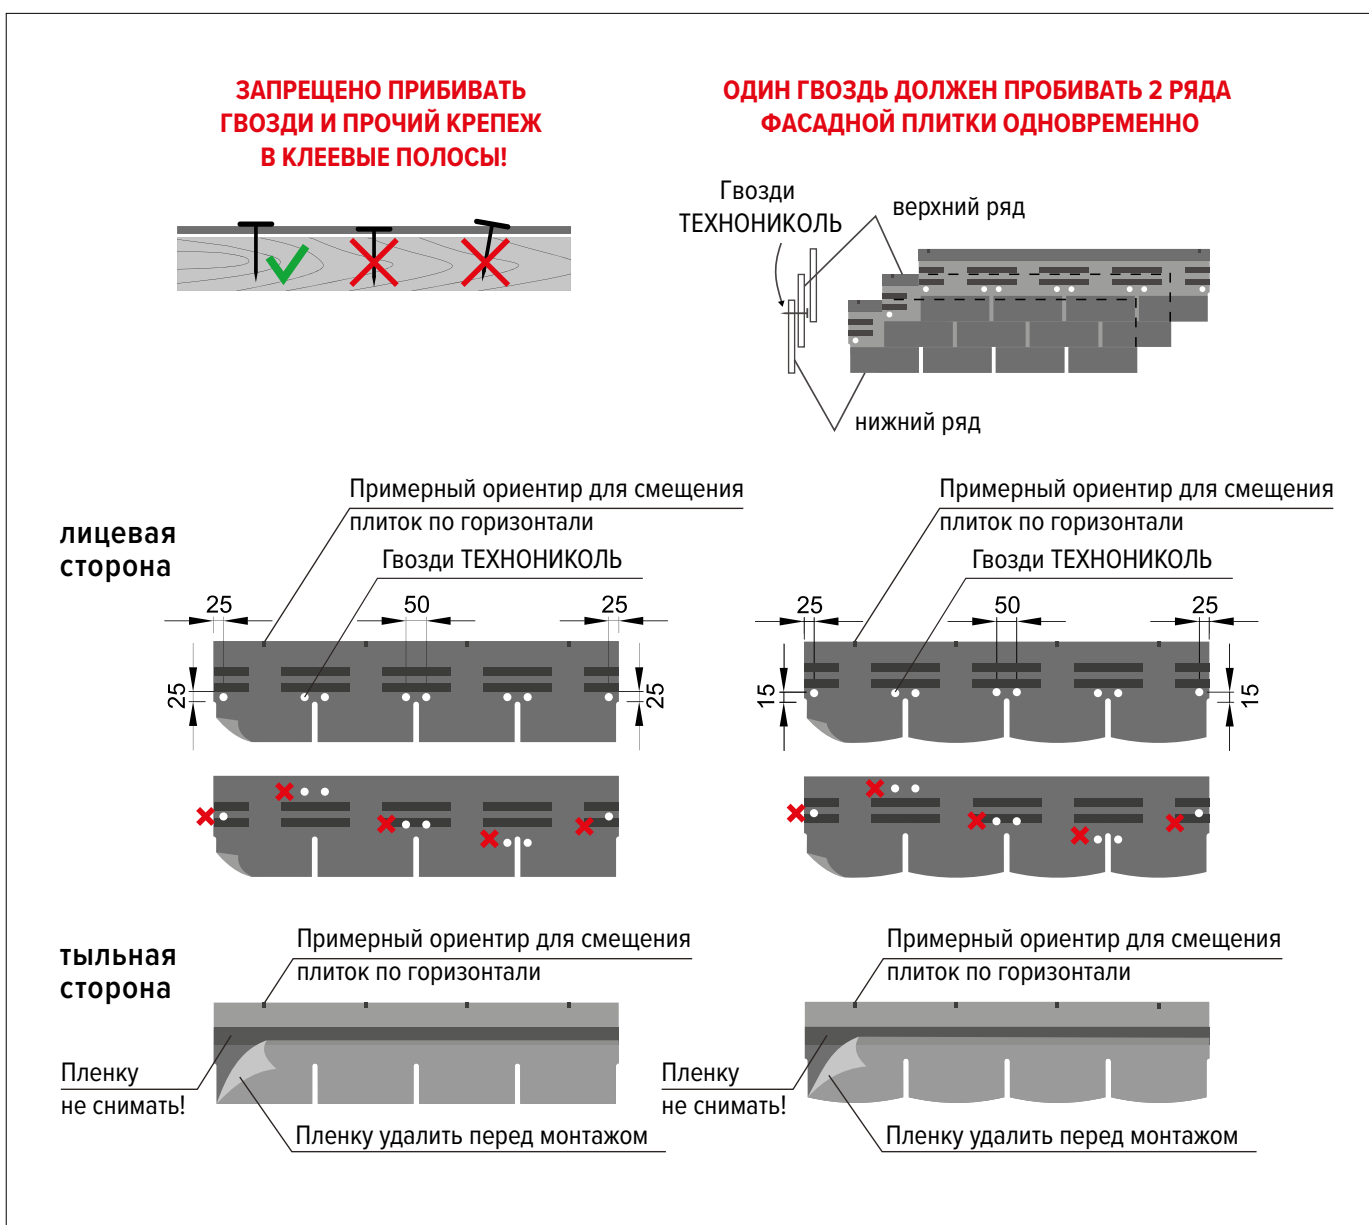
Схема крепления фасадной плитки на 8 гвоздей
